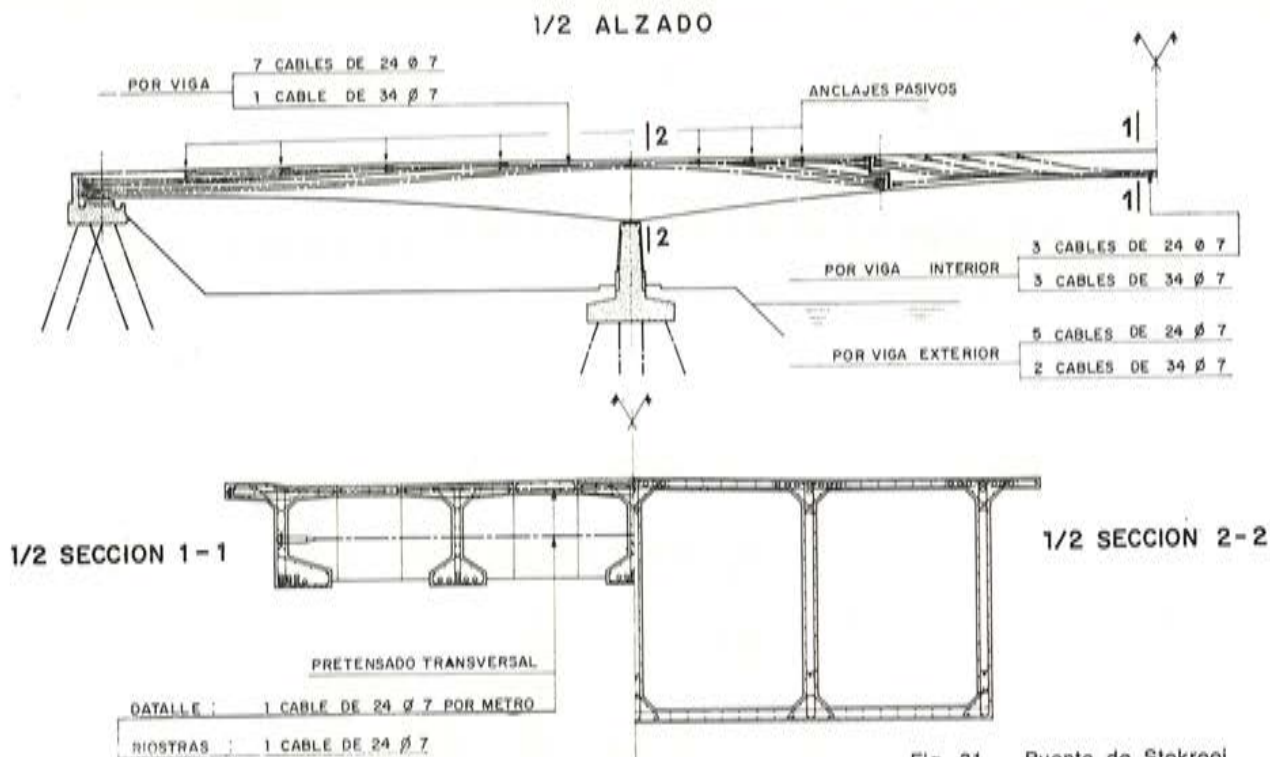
Puente de Stokrooi. Trazado de cables y distribución de armaduras.
